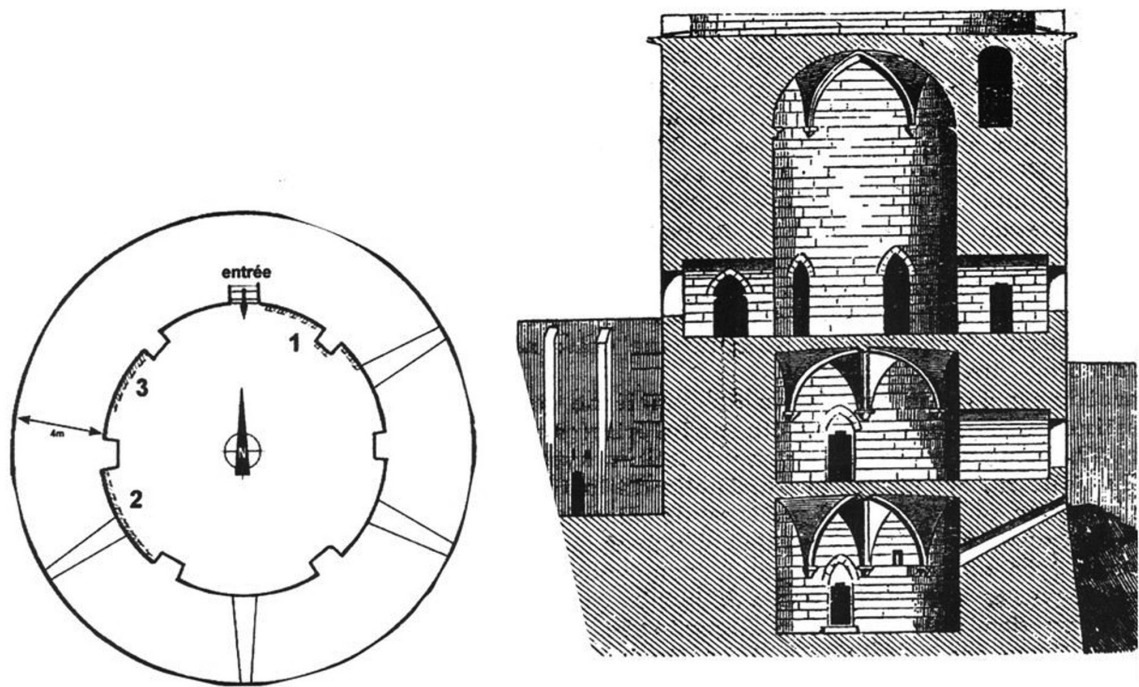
La torre dei Prigionieri nel castello di Gisors. Pianta e sezione in una raffigurazione dell'inizio del XX secolo.
